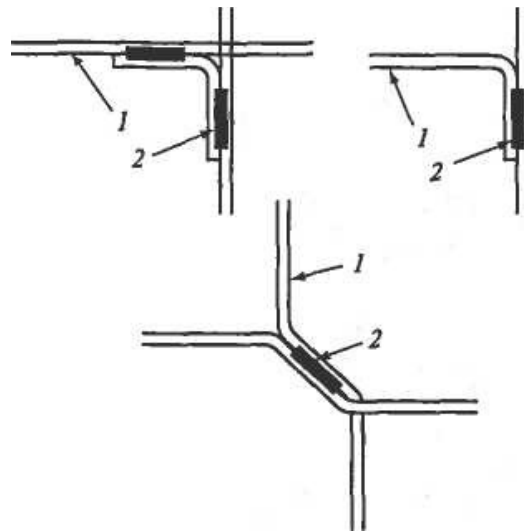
Выполнение сварных соединений арматуры железобетонных конструкций:
